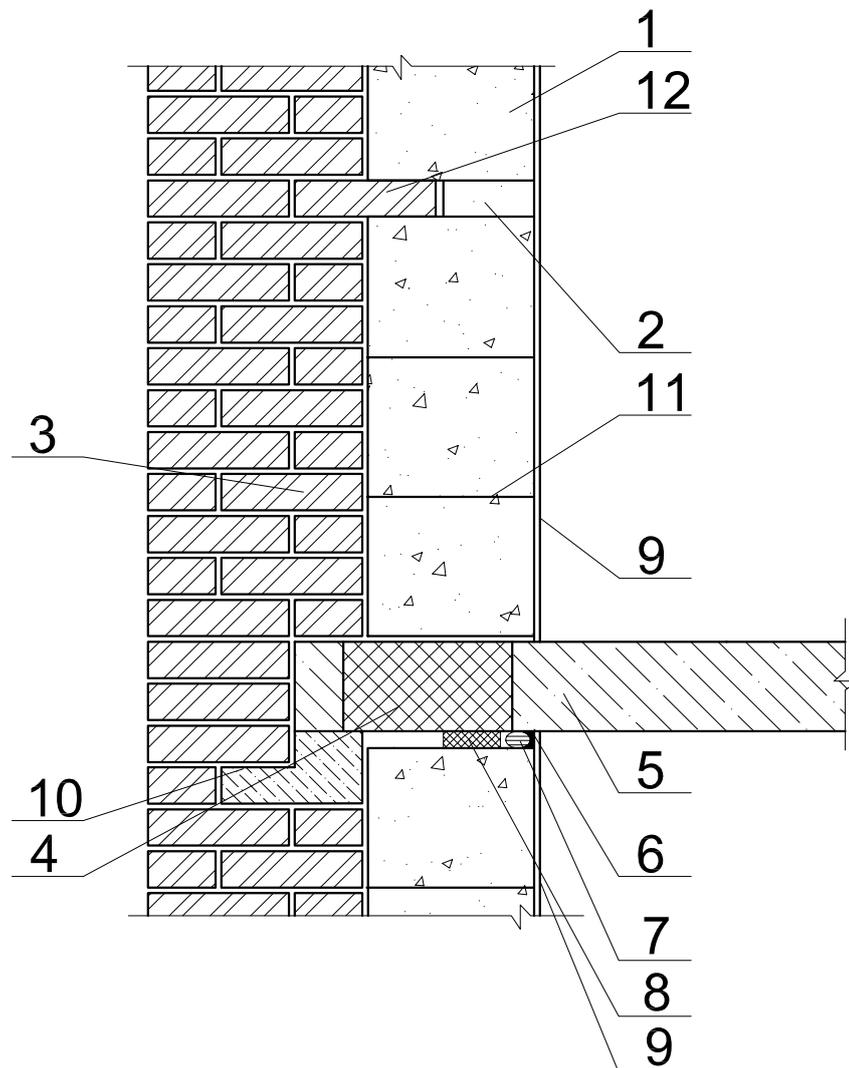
Несущая кирпичная стена с наружными газобетонными самонесущими блоками ГРАС и кирпичной облицовкой
